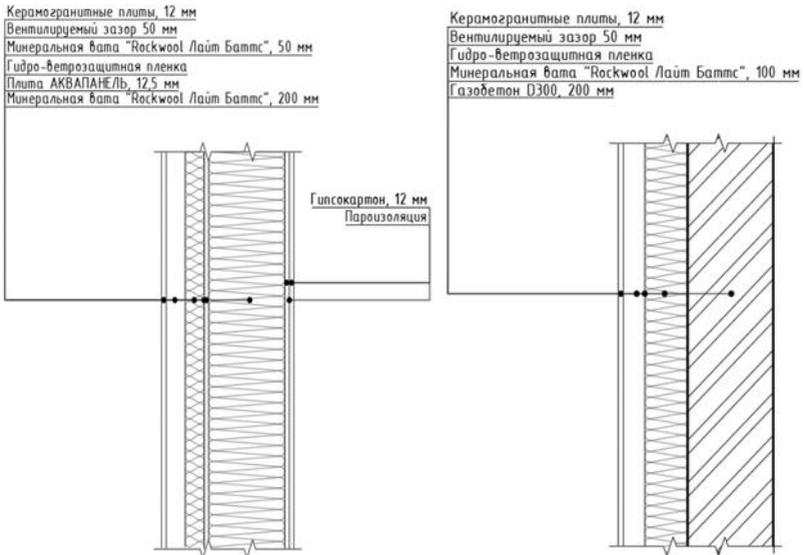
Состав элемента каркасно-обшивной стены (слева) и стены из газобетона (справа)
